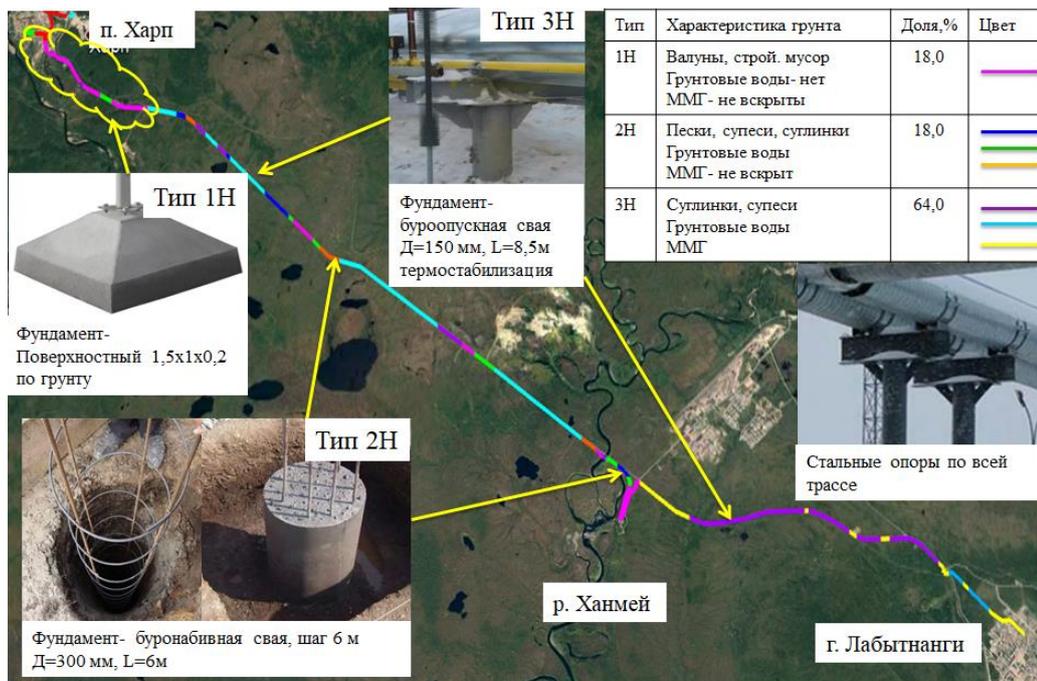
Схема прокладки водопровода для Варианта 1
